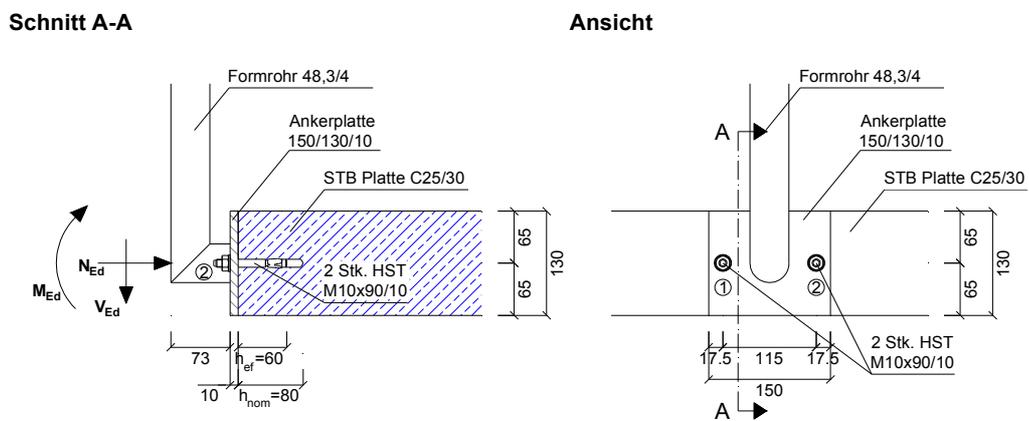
Anschlussdetail G1 Dübel Variante 1 (Maße in mm)
